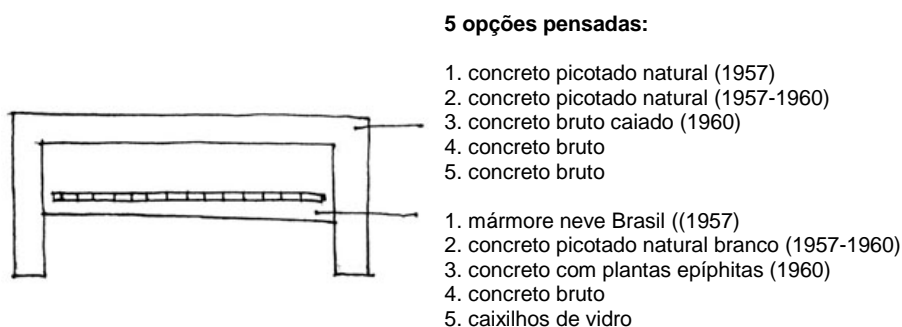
Interpretação esquemática dos acabamentos da fachada.
